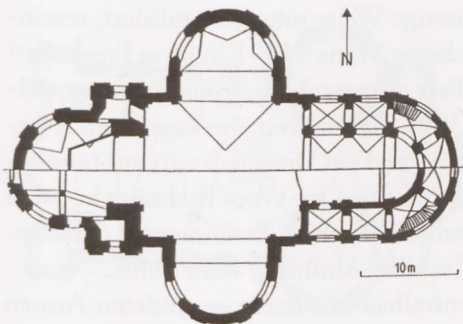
Vilgertsbafen, Wallfahrtskirche
